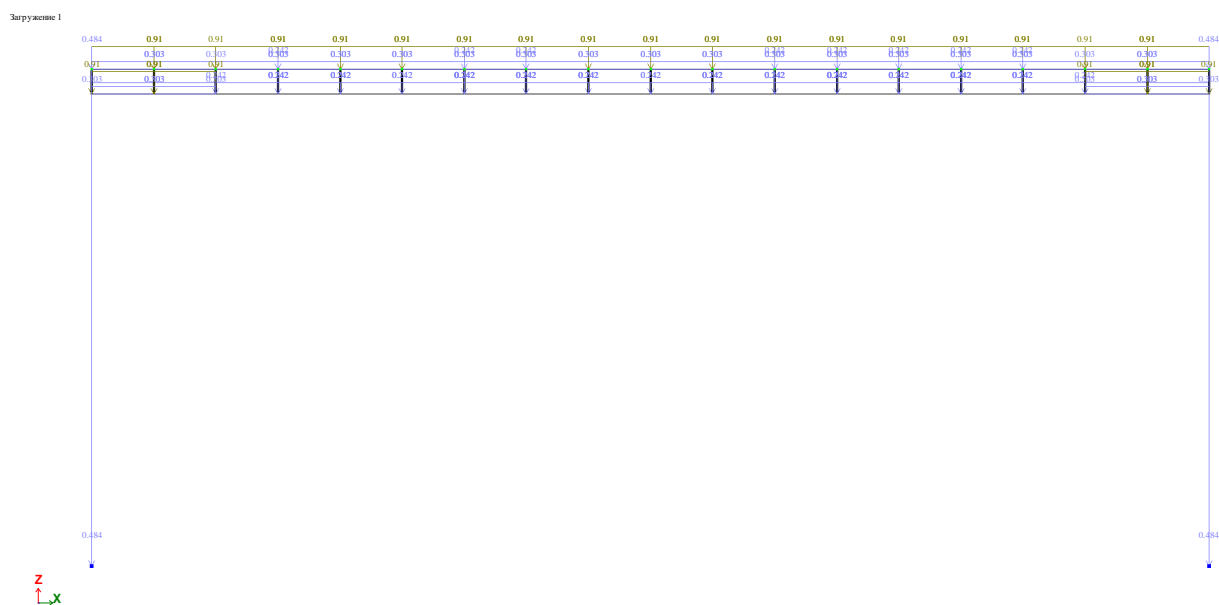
Схема нагружения на перекрытие в проекции XOZ
